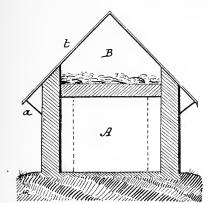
Coupe transversale d'un fruitier à simples parois.
